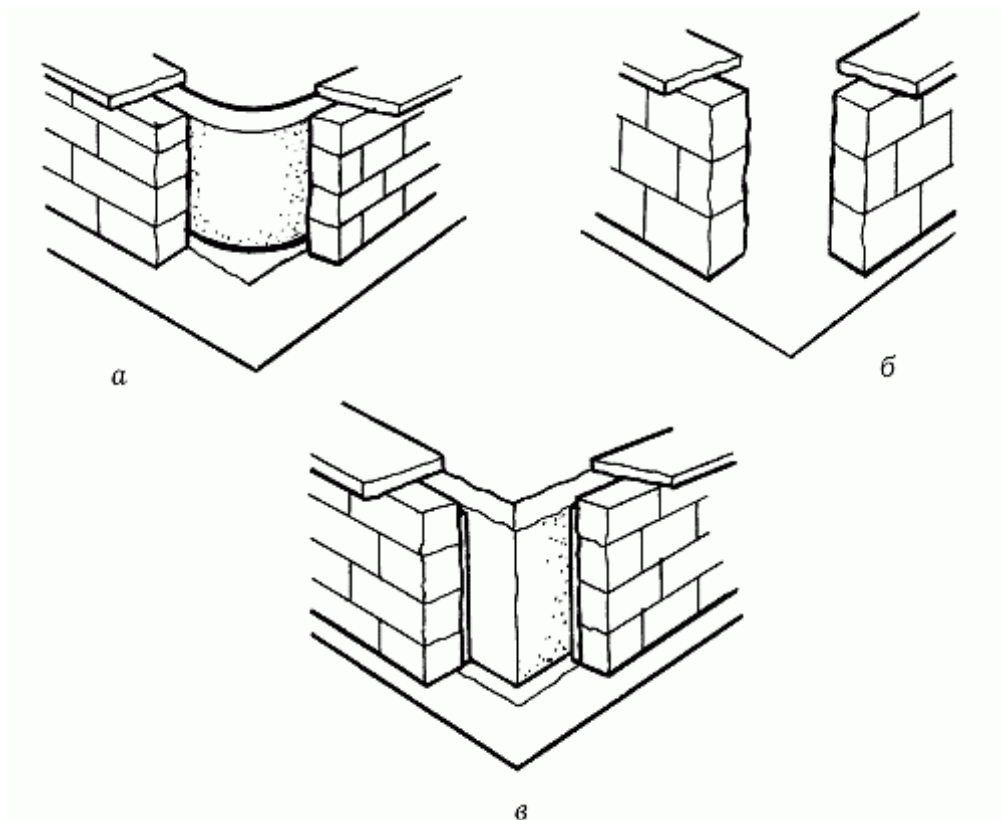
Варианты строительства приподнятого пруда: а – использование жесткой формы на песчаной подушке; б – использование водонепроницаемой пленки из полистирола; в – использование бетонных блоков
